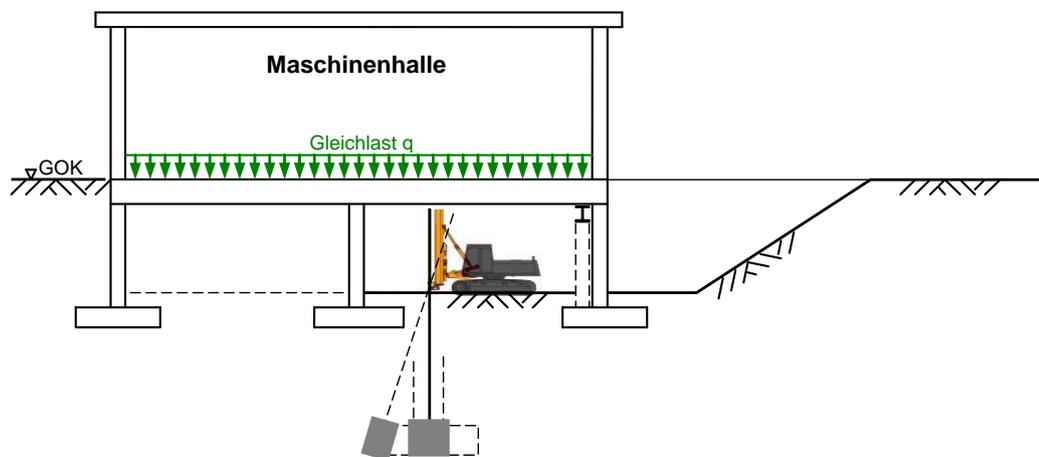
Bauphase – HDI Körper herstellen für untere Abfangkonstruktion
